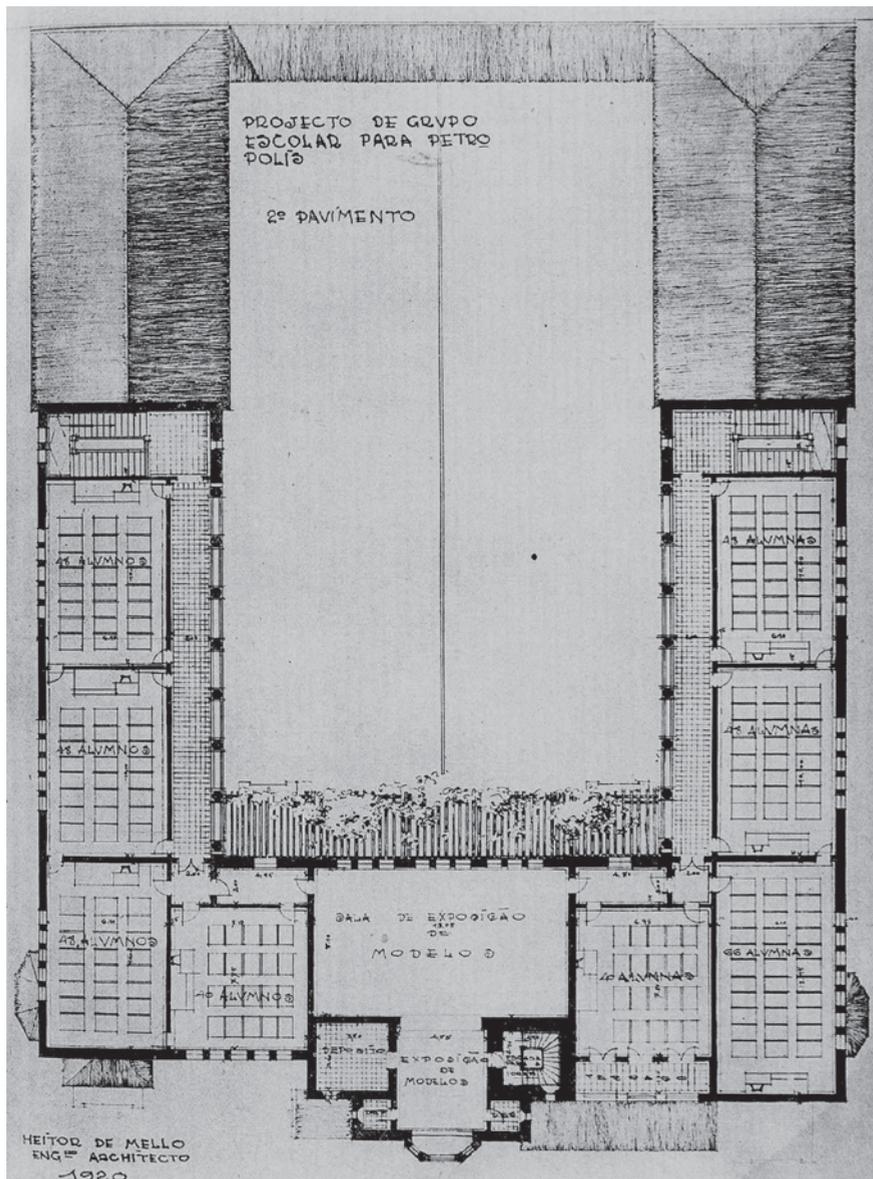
Planta baixa do Grupo Escolar Pedro II, em Petrópolis, 2º pavimento
